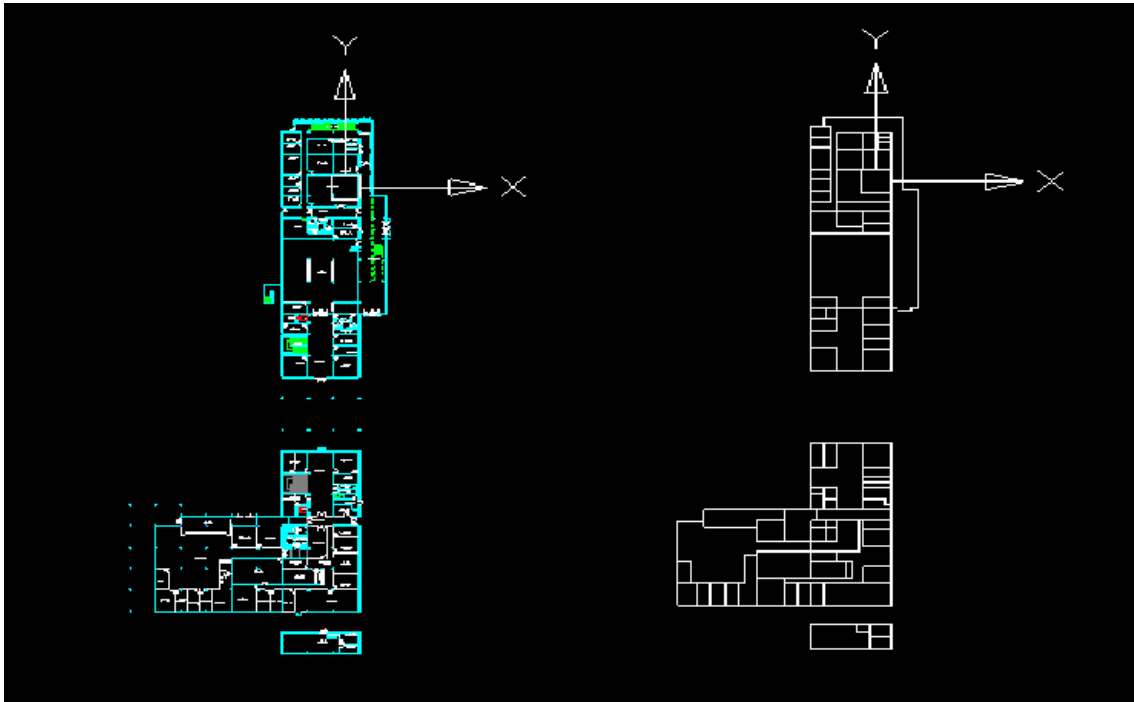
Comparativa entre el plano de la planta baja original y el simplificado
